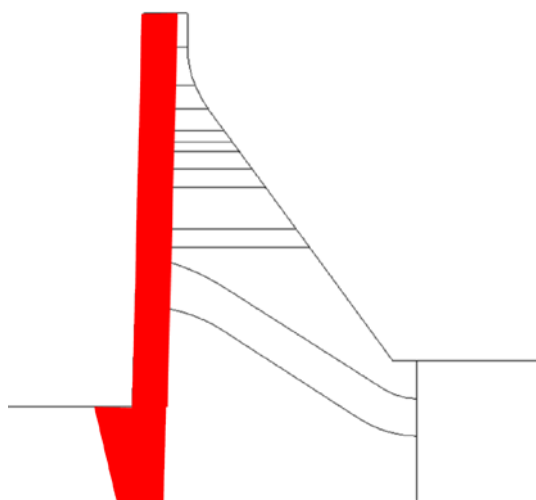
Zona en que se han aplicado las deformaciones impuestas (en color rojo).
